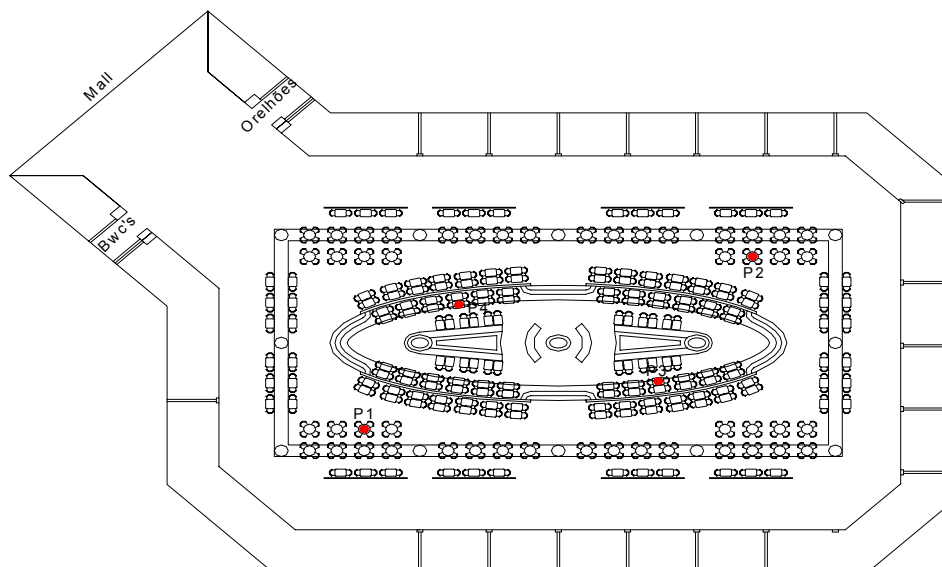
Planta esquemática e pontos de medição do nível de pressão sonora: Praça de alimentação do shopping L
